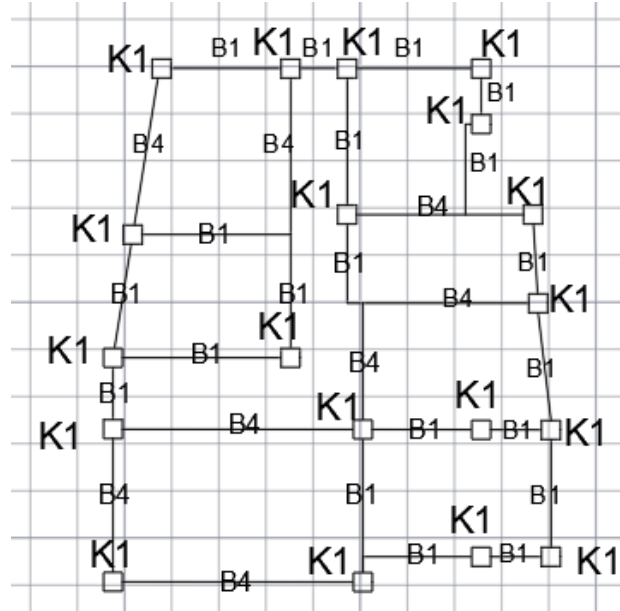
Hasil Akhir Desain Dimensi Balok dan Kolom Bangunan B3
